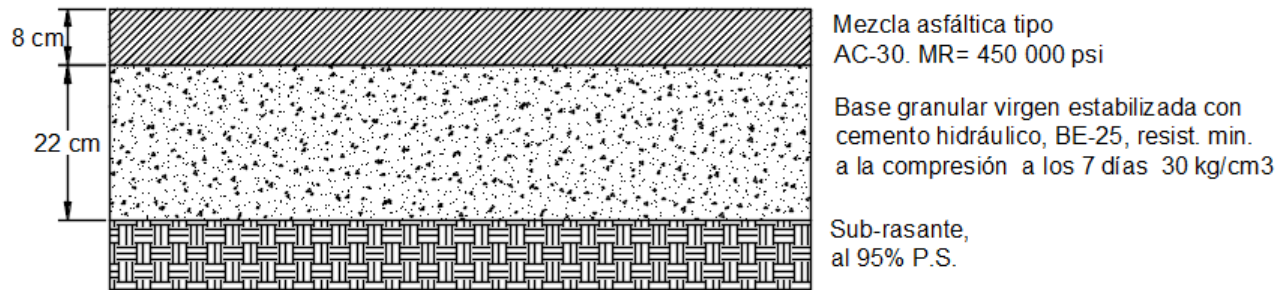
Perfil de la estructura de pavimento propuesta para el TH=40.
